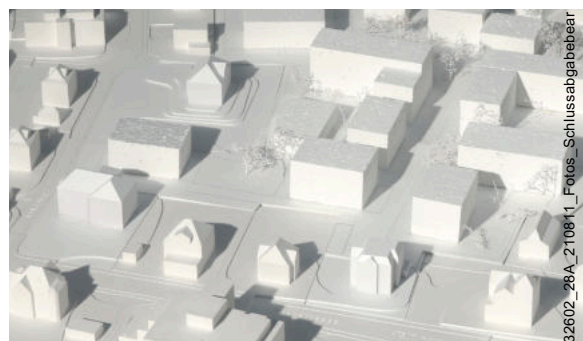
Modellfoto Schulcampus, Team camponovo baumgartner architekten
